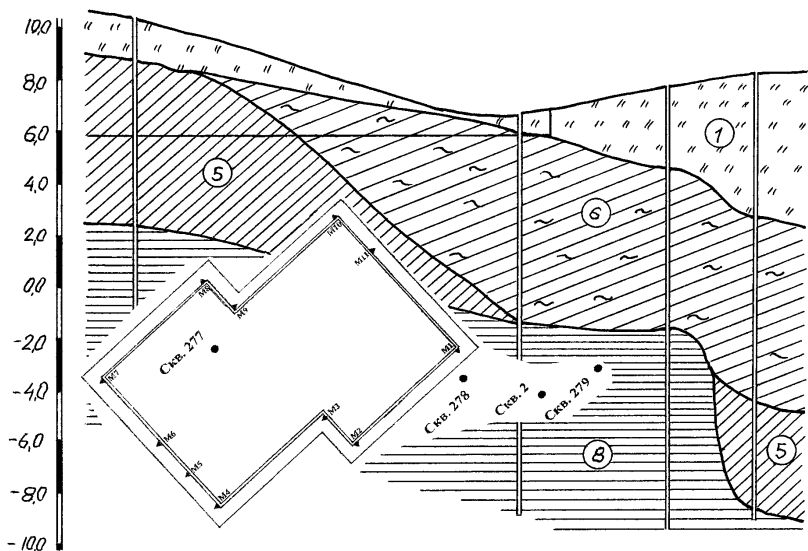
Инженерно-геологический разрез по скважинам №277 – №279; план-схема их расположения относительно фундаментной плиты
